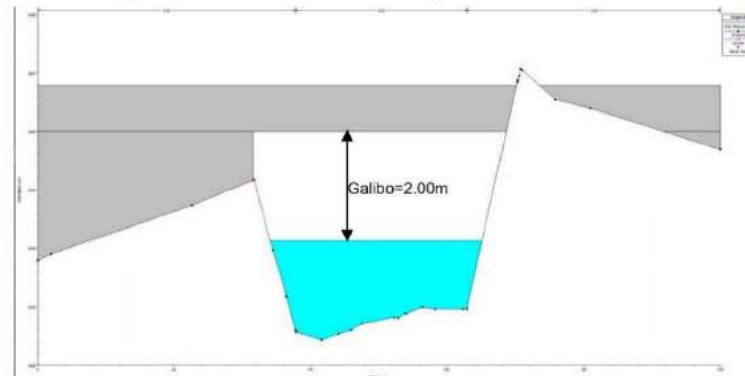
Sección puente provisional para un Tr de 50 años
